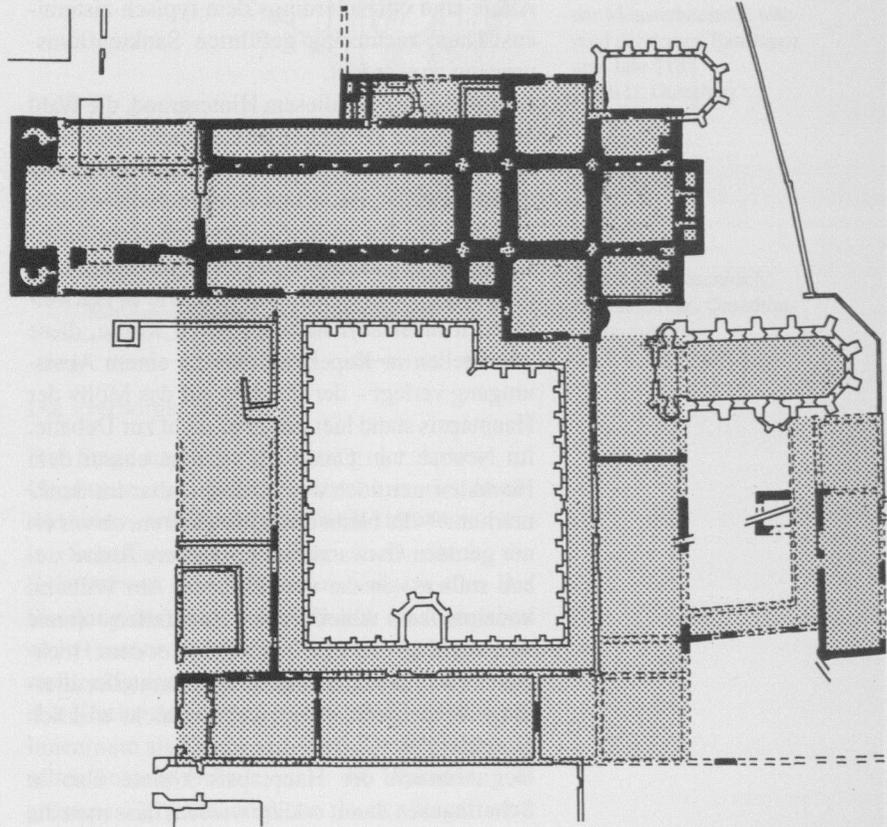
Hirsau, St. Peter und Paul. Grundrissrekonstruktion (nach O. Teschauer). M. 1:1000.
